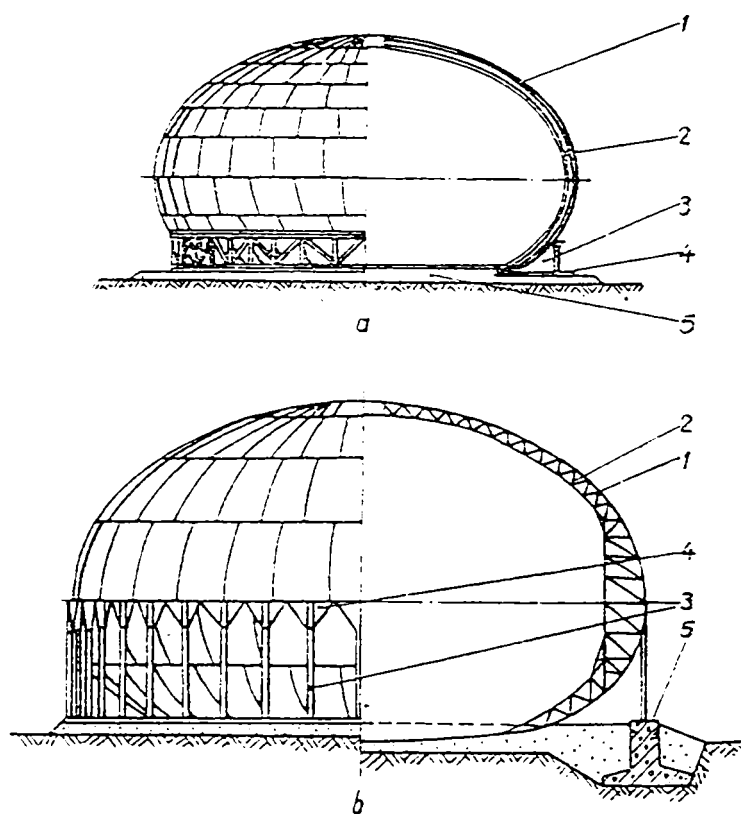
Rezervor în formă de picătură a) cu fund plat b) cu fund curb
